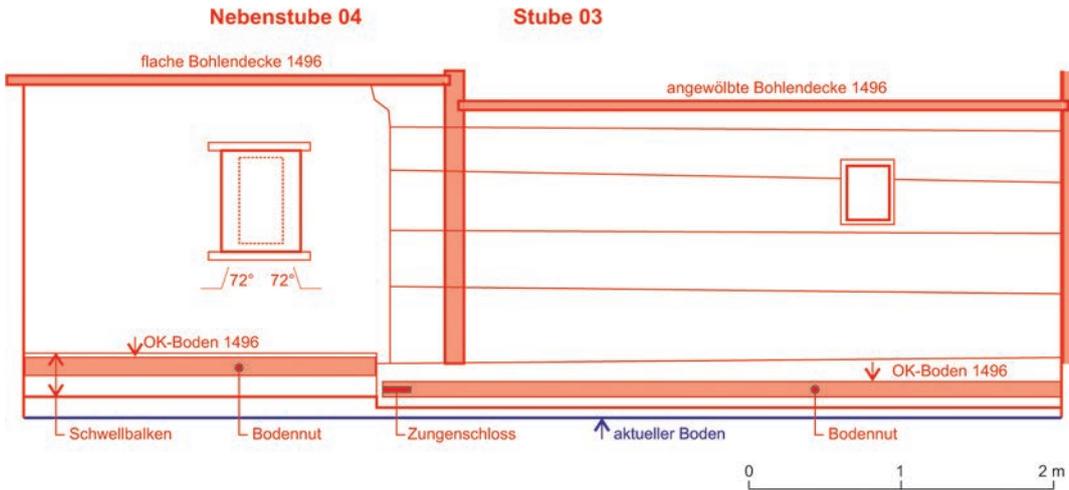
Planzeichnung der Südwand von Stube und Nebenstube mit Konstruktionsdetails und den Fenstern aus dem 15. Jahrhundert. M. 1:50.
